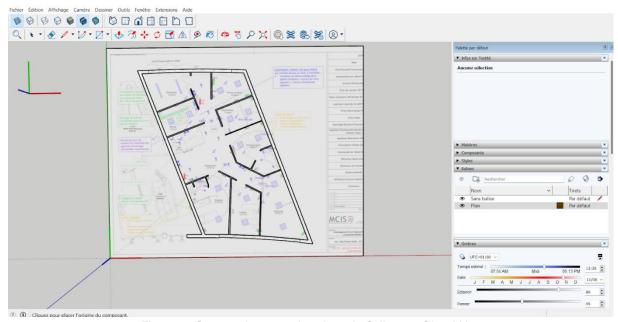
Contour des murs des plans du CHL sur « SketchUp »
